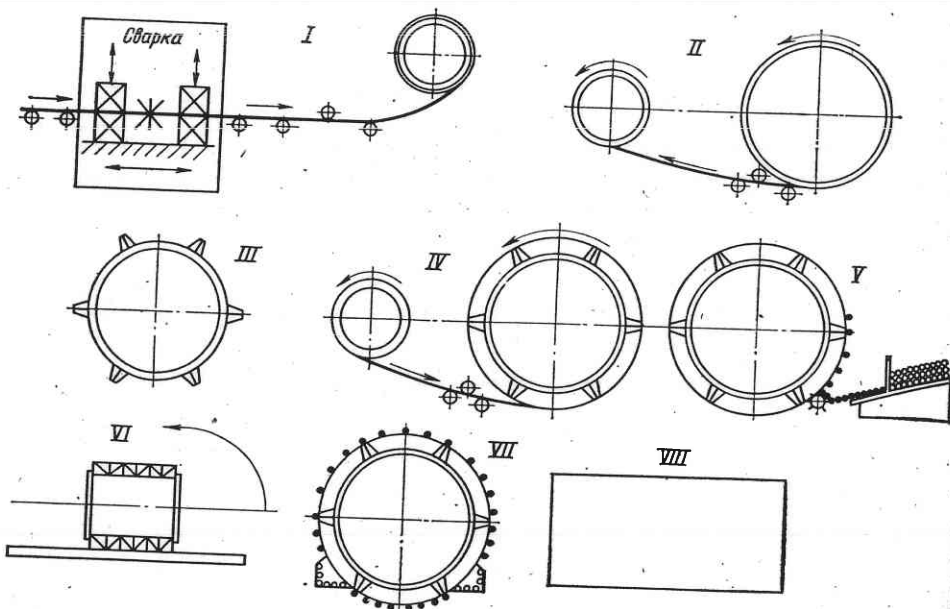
Последовательность изготовления спирального армокаркаса сталежелезобетонного трубопровода
